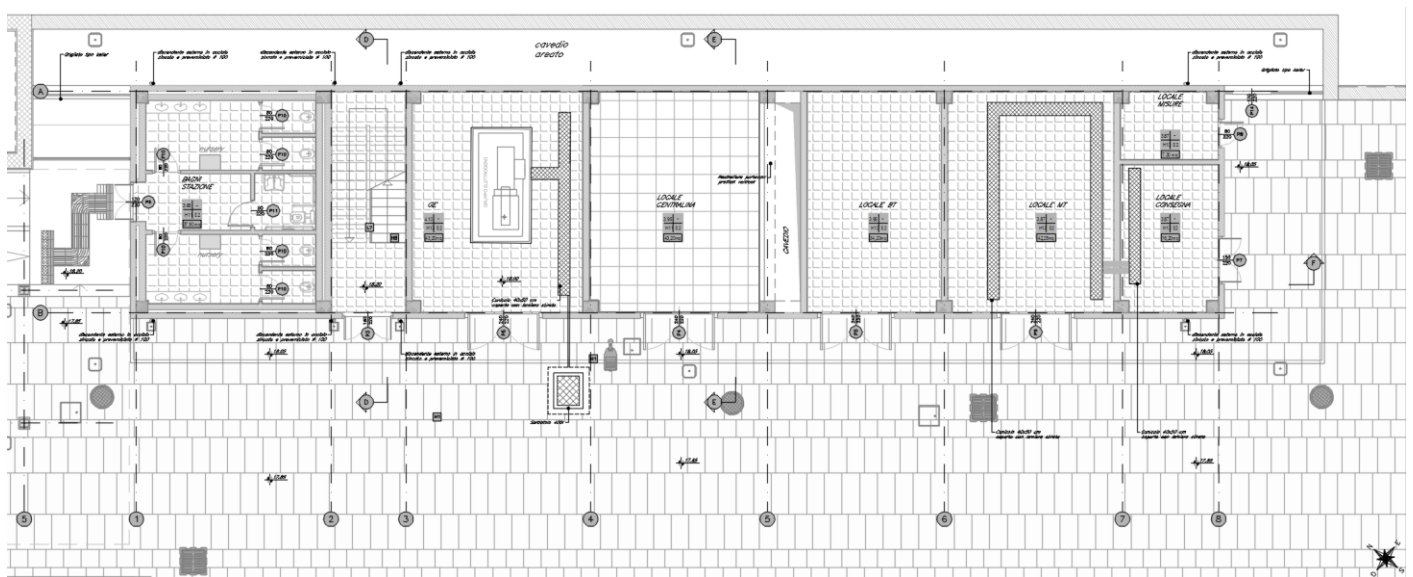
Stralcio pianta fabbricato tecnologico – piano terra
